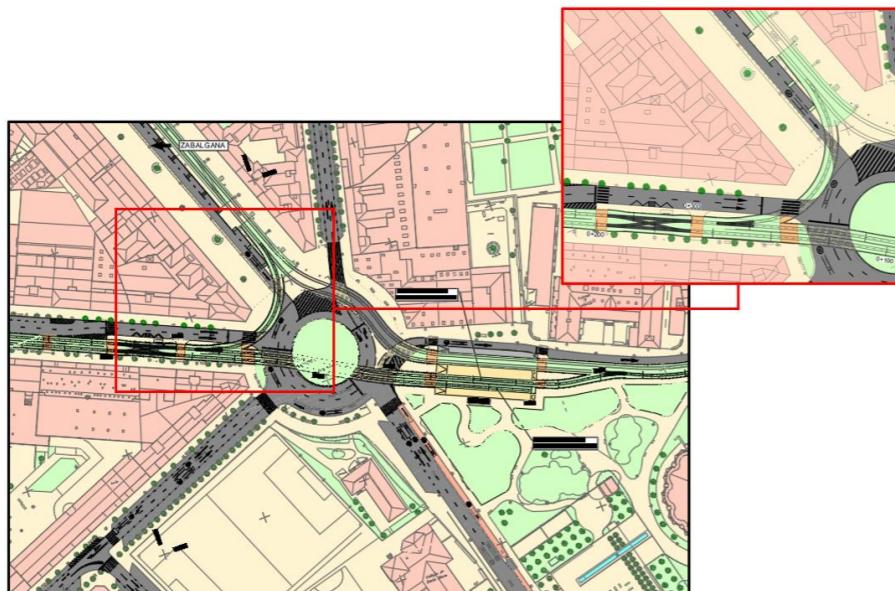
Afección a infraestructura existente en Sancho el Sabio.
